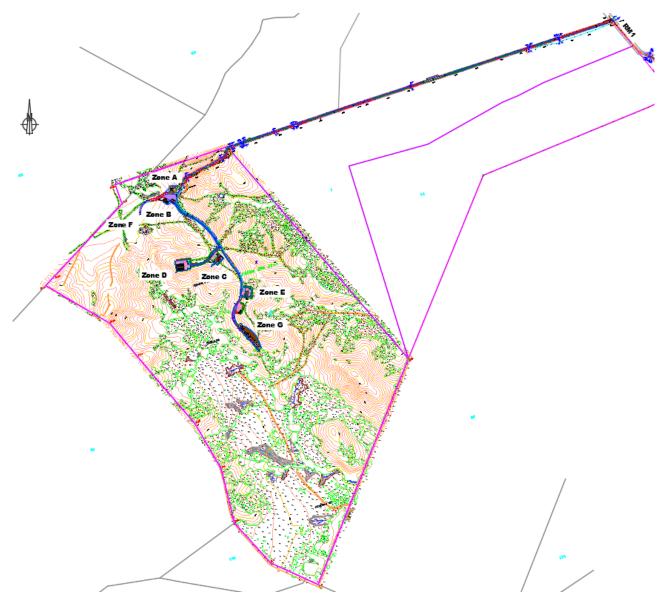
EXTRAIT PLAN PROJET (SOURCE: BECIB)
